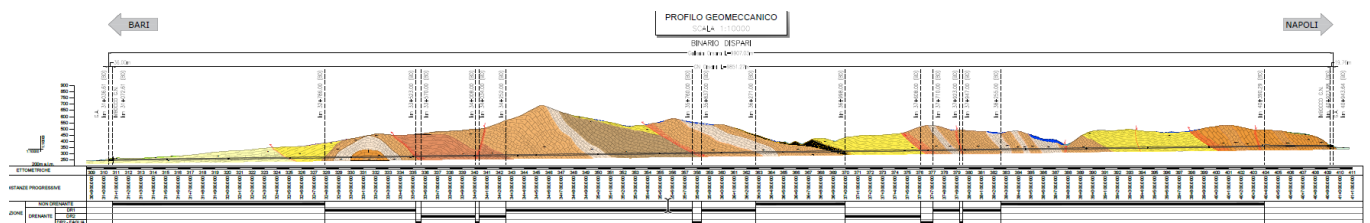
Layout tratte di applicazione sezioni impermeabili / drenanti
